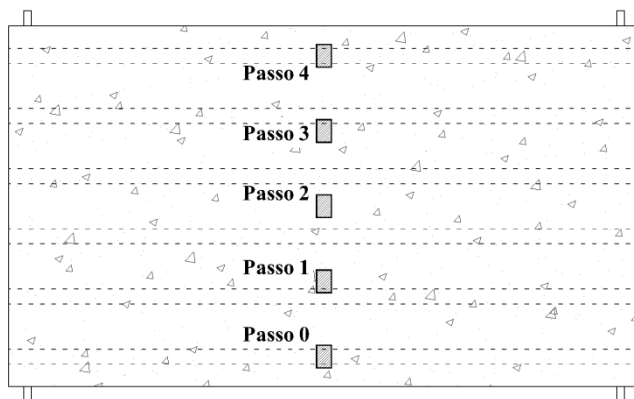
Posição da aplicação do carregamento de caminhar na laje LM-3 Faixas.
